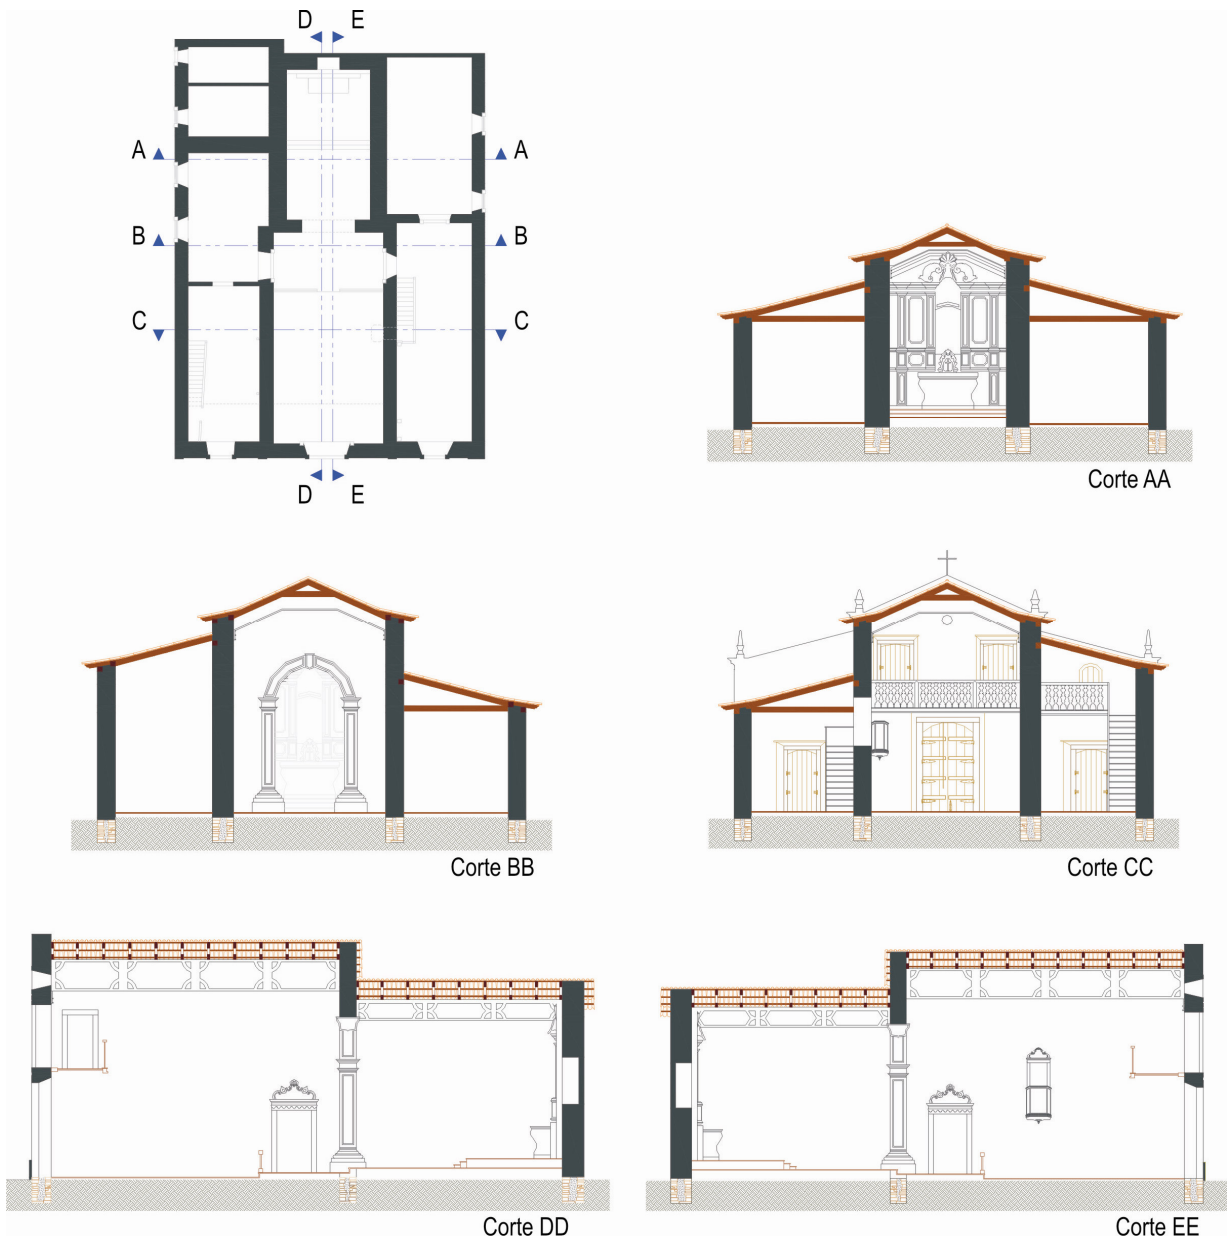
Planta Baixa e Cortes igreja São Francisco de Paula
